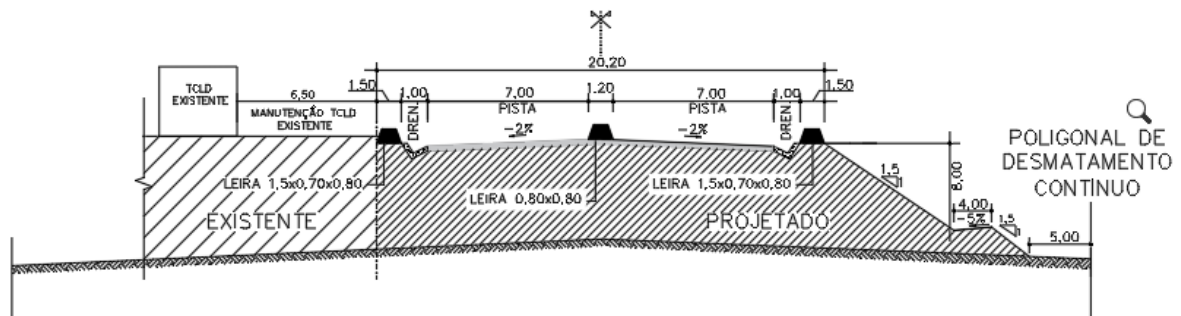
Vista da Seção Tipo Projetada da estrada – SEÇÃO DE ATERRO
